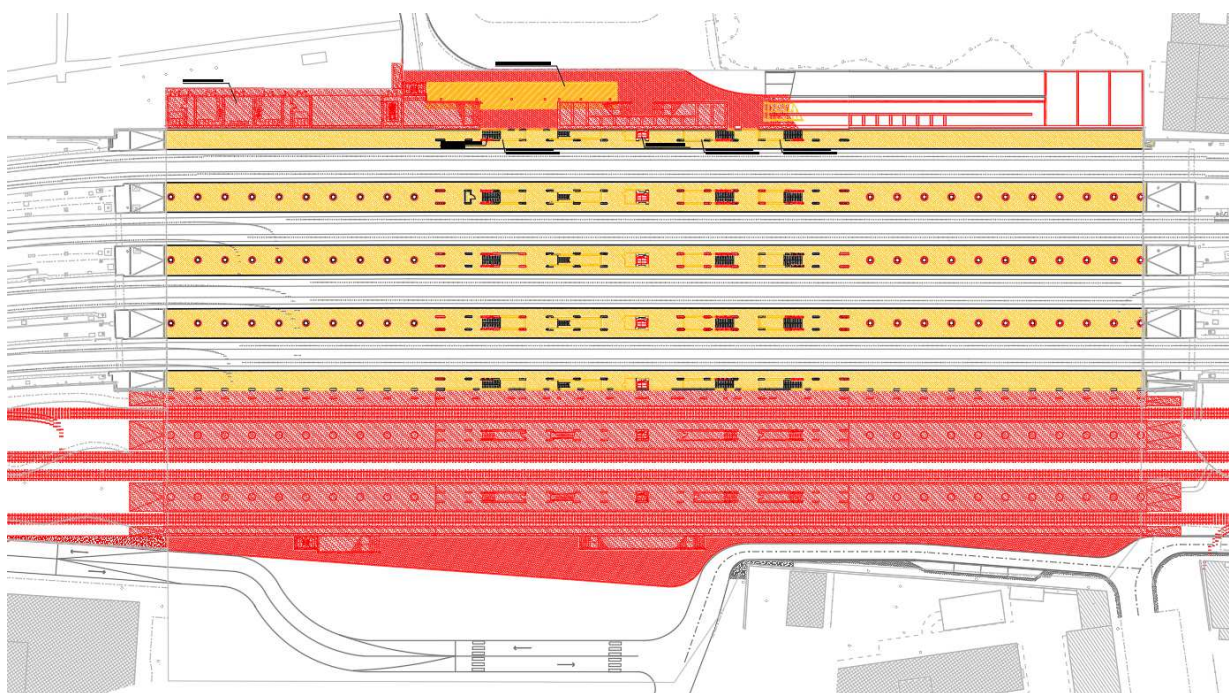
Planimetria demolizioni Piano Banchine Stazione di Bovisa (demolizioni in giallo)
